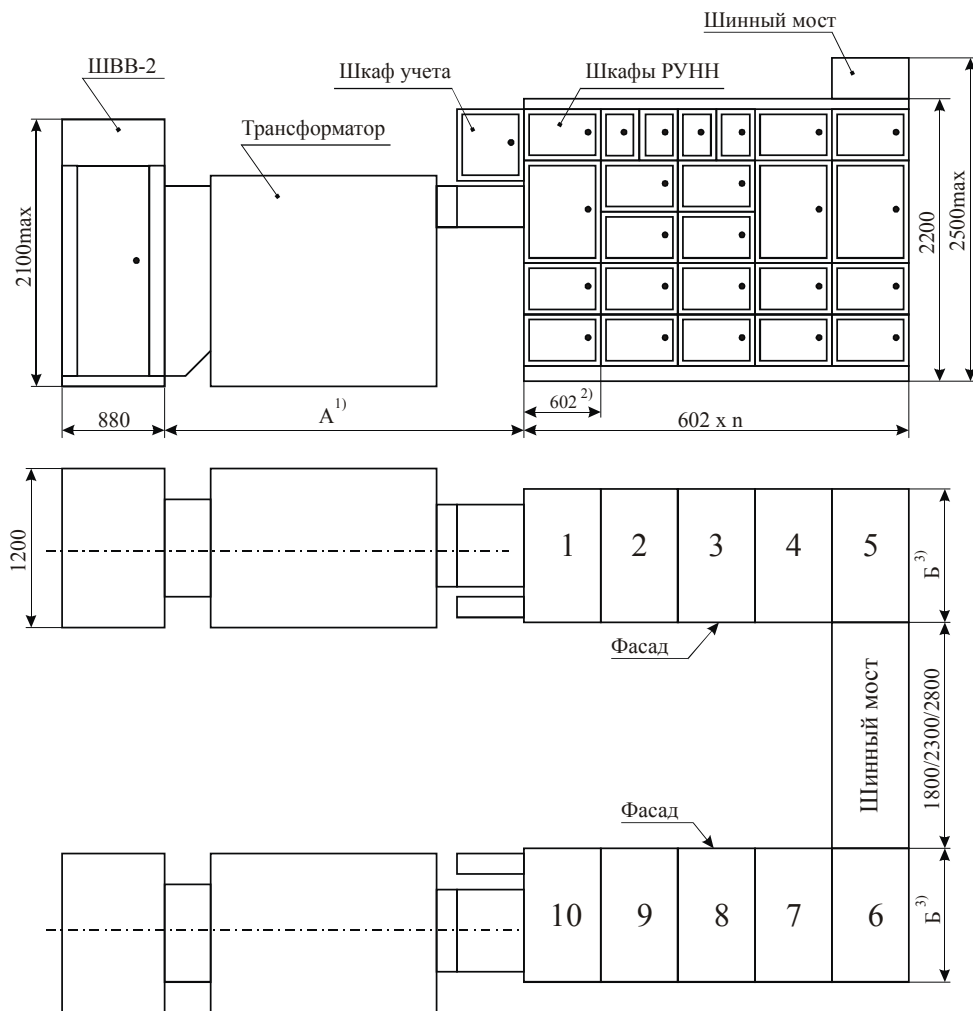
Габаритно-установочные размеры КТПА (2КТПА) 630 – 1600 кВА двухрядного исполнения
